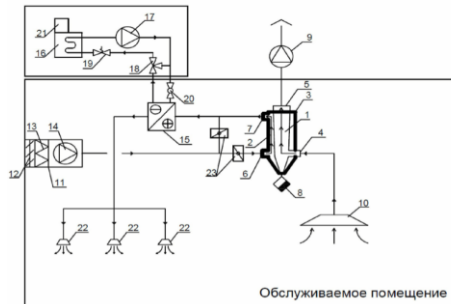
Схема системы вентиляции животноводческих помещений:
